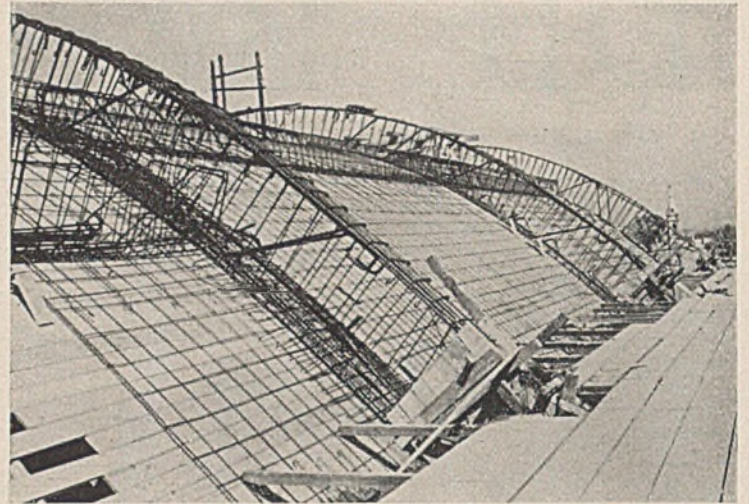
Bewehrung des Bogens und der Dachdecke der Haupthalle.
